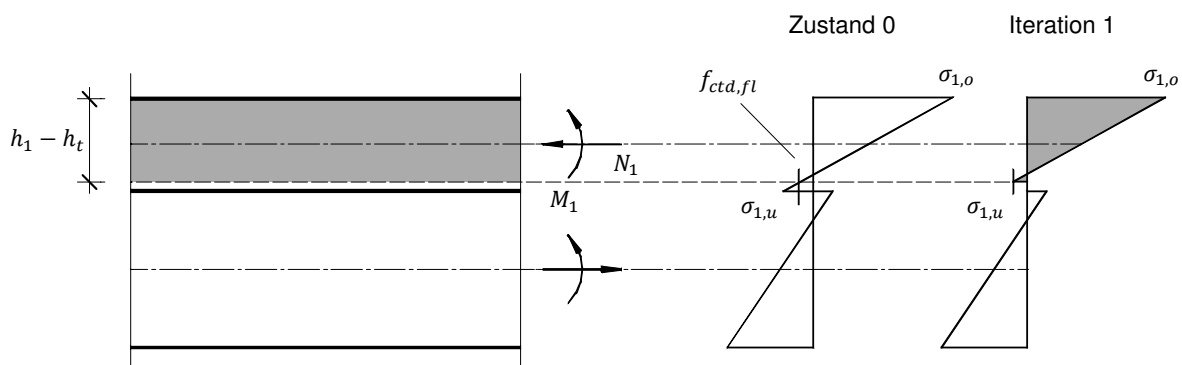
Gerissene Betonzugzone – globale Kräfteumlagerung
